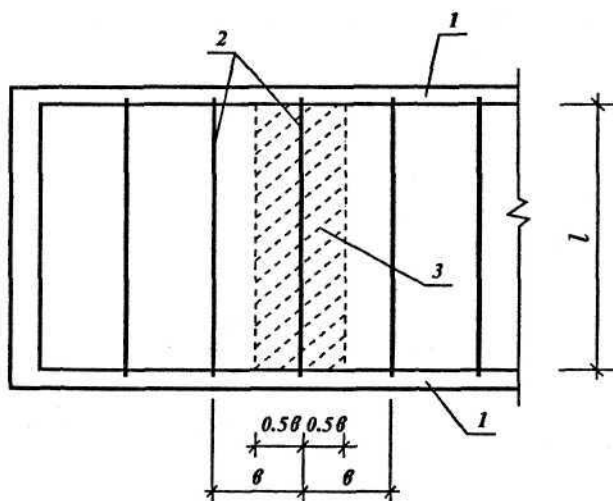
Схема сбора нагрузки на несущую опорную балку:
